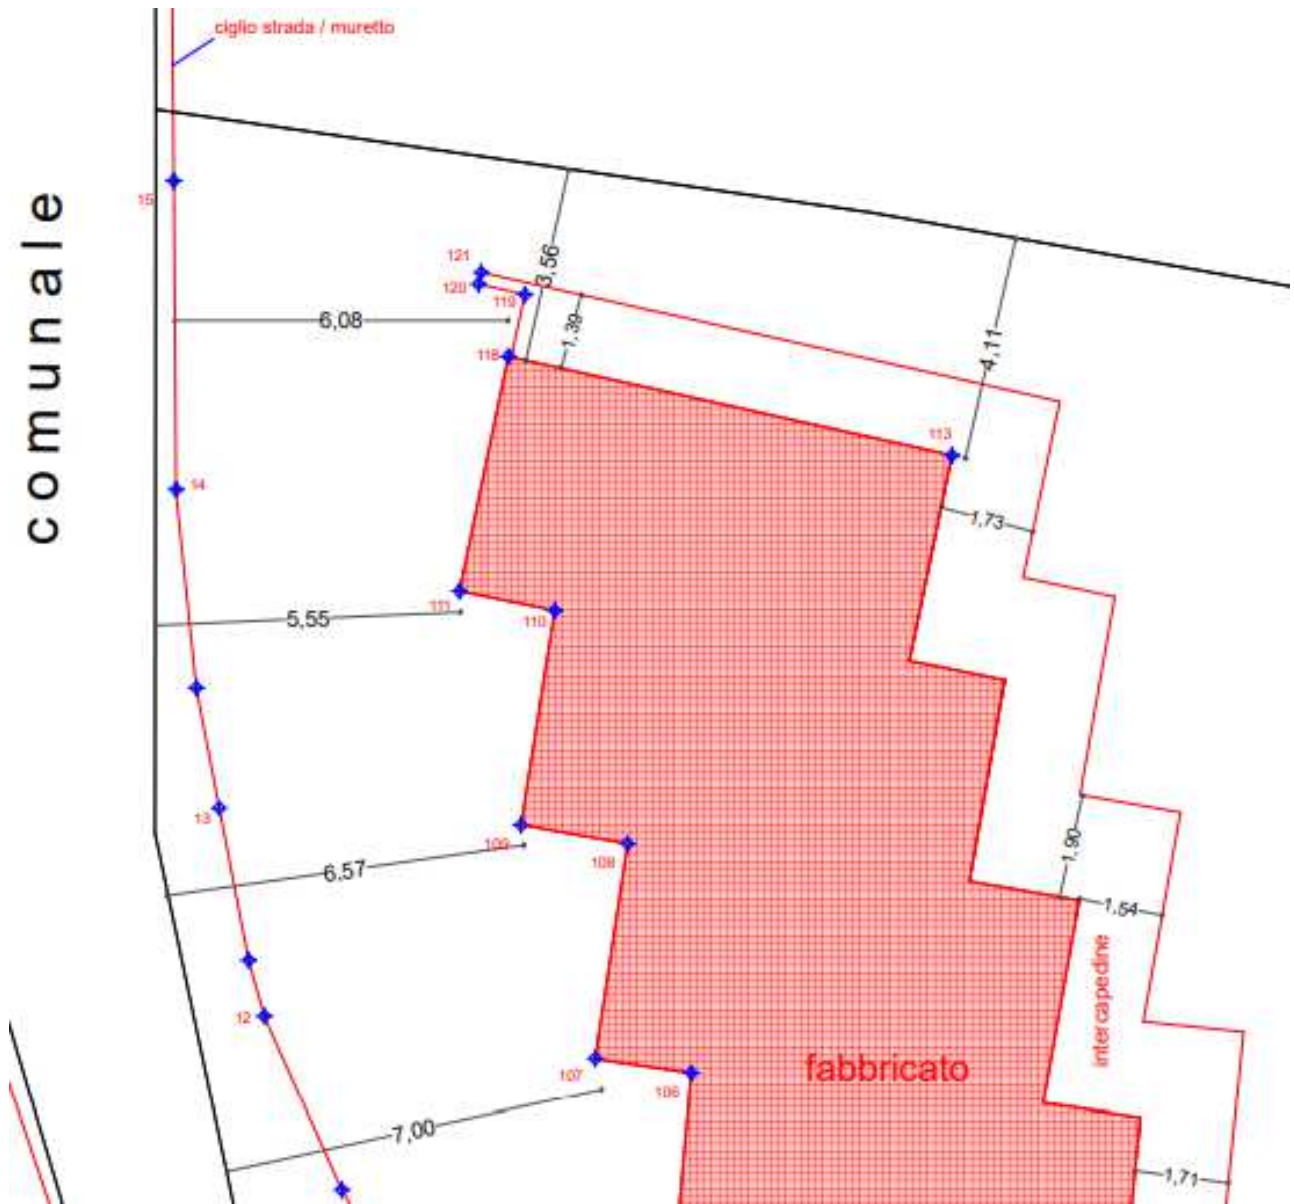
Rilievo planimetrico ed inquadramento catastale – zoom porzione Sud
